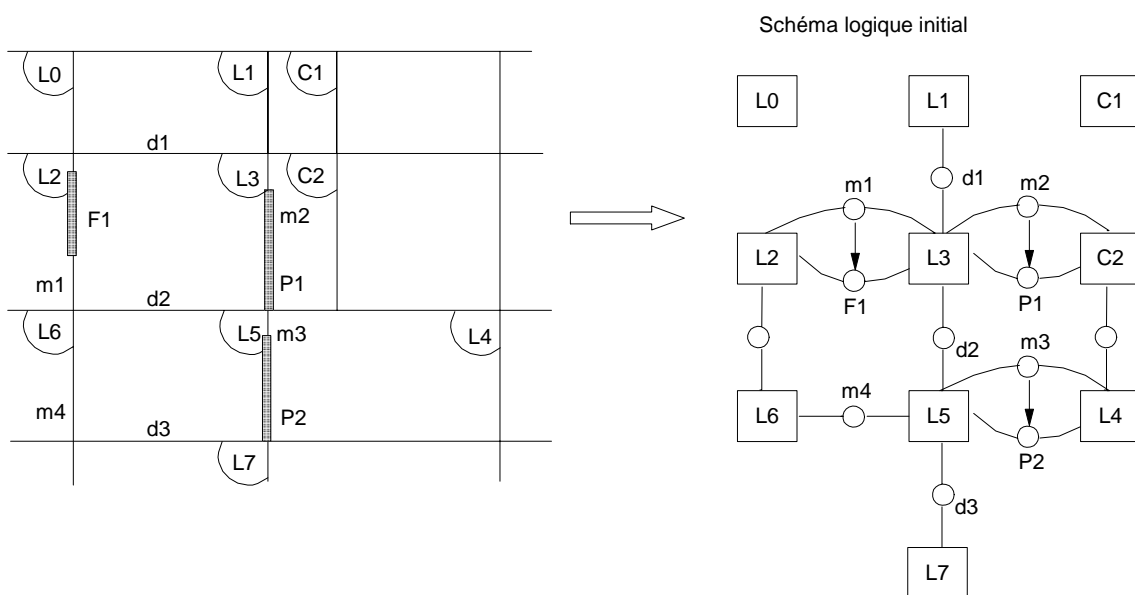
Coupe verticale pour fusion complexe dans le plan vertical
